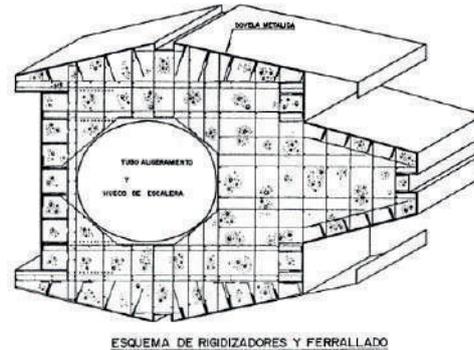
Corte transversal 3D de la pila. Puente del Alamillo. FCC 1.992
